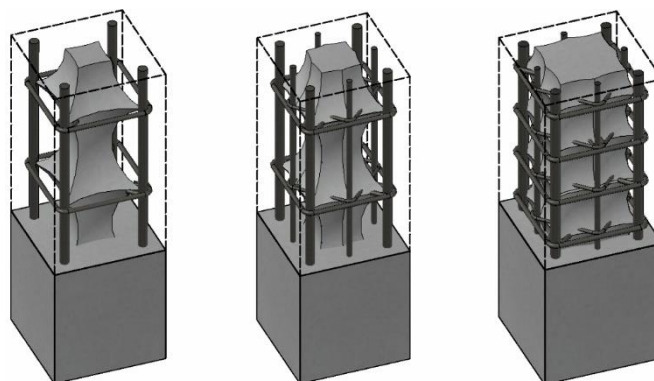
Schematische Darstellung des umschnürten Betonkerns bei Stahlbetonstützen mit unterschiedlichen Bewehrungsanordnungen
